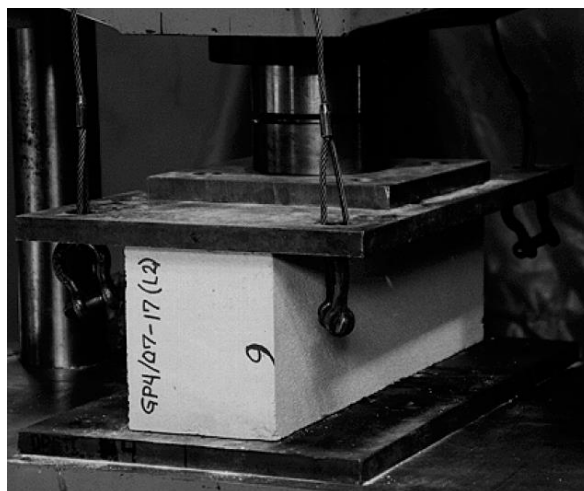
Ensaye a compresión de un bloque de CCCA, en una maquina universal
